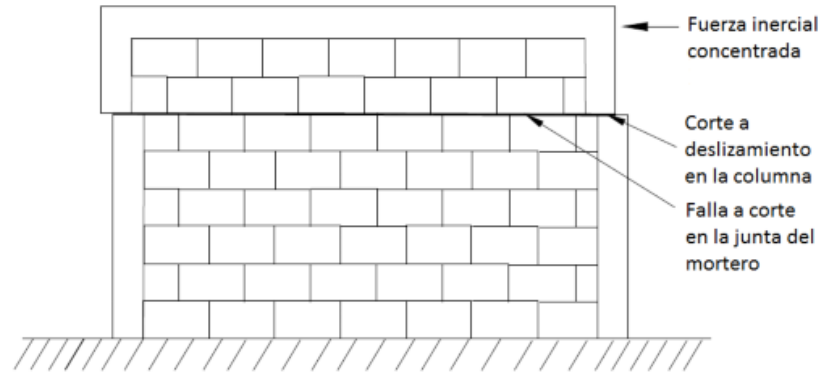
Falla a deslizamiento en el panel de mampostería
